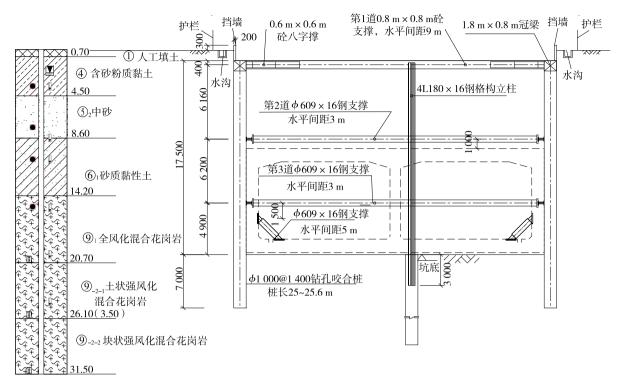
工程地质状况和基坑围护结构断面图(单位:标高为 m,其他为 mm)
